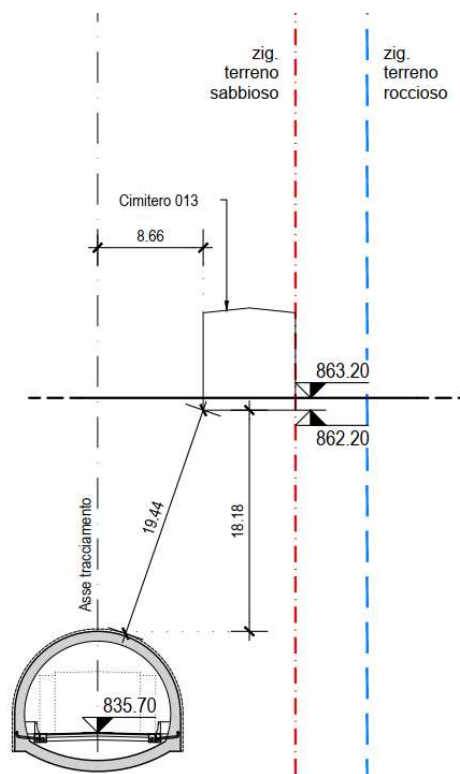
Sezione verticale dell'immobile rispetto alla galleria
